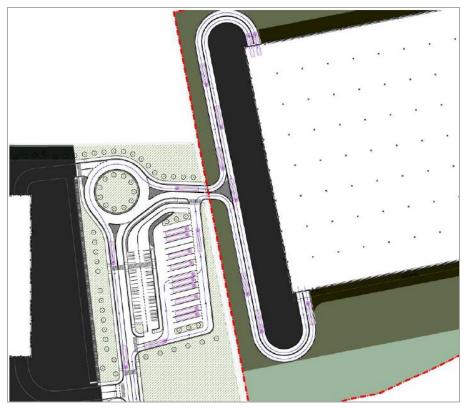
Planimetria d'insieme con individuazione della movimentazione dei mezzi e degli spazi di sosta
